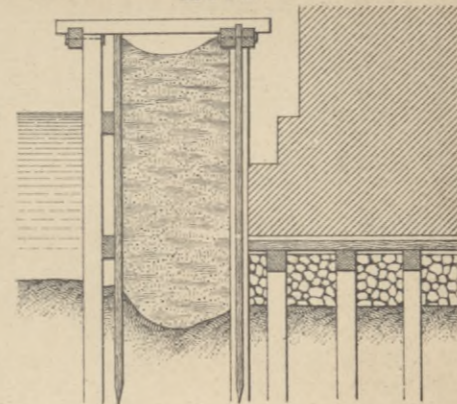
Futtermauer der Docks zu Hull. M. 1:250. A cross-sectional diagram of a concrete retaining wall for docks in Hull.
